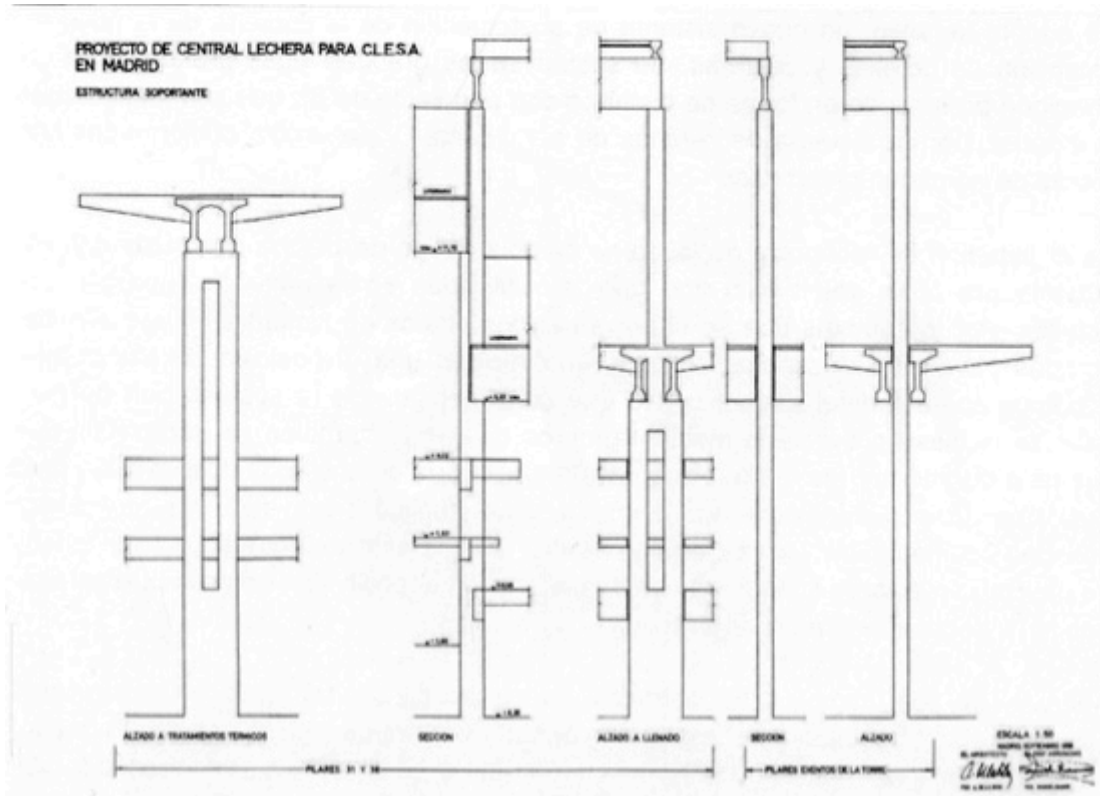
Plano de estructura: "pilares especiales". 1961.
